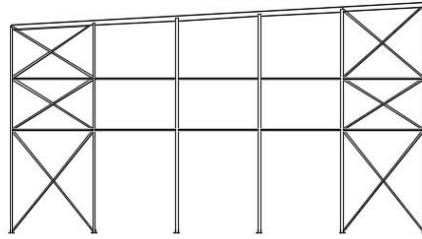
Pórtico de Fachada N. (Fuente: Cype 3D)
